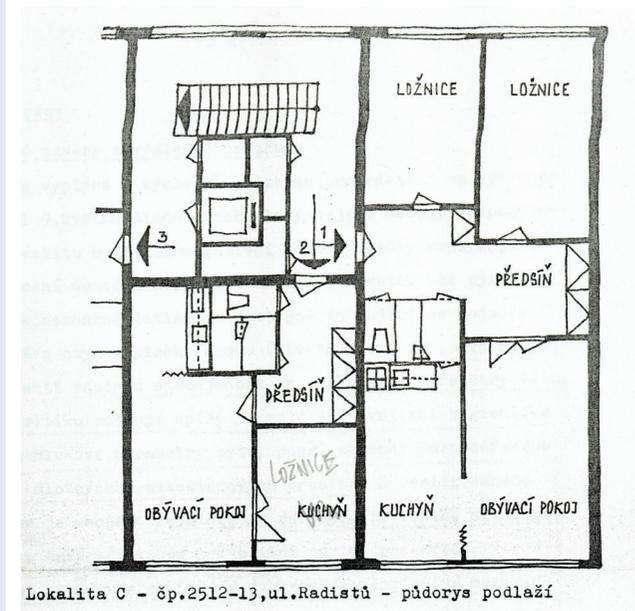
9.Kvetna Beispiel Grundriss 3
